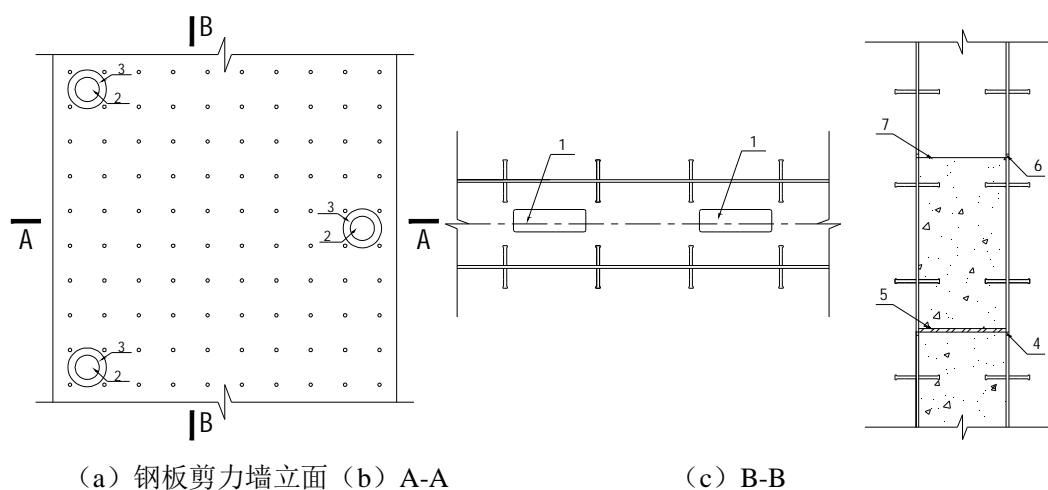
混凝土灌浆孔、流淌孔、排气孔和排水孔设置
